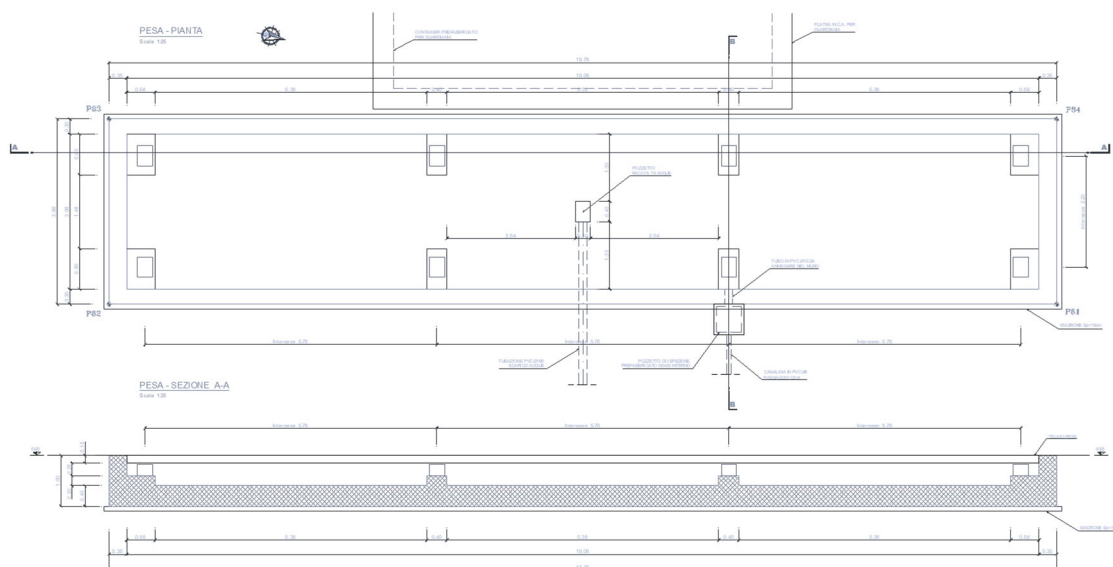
PIANTE E SEZIONE LONGITUDINALE
